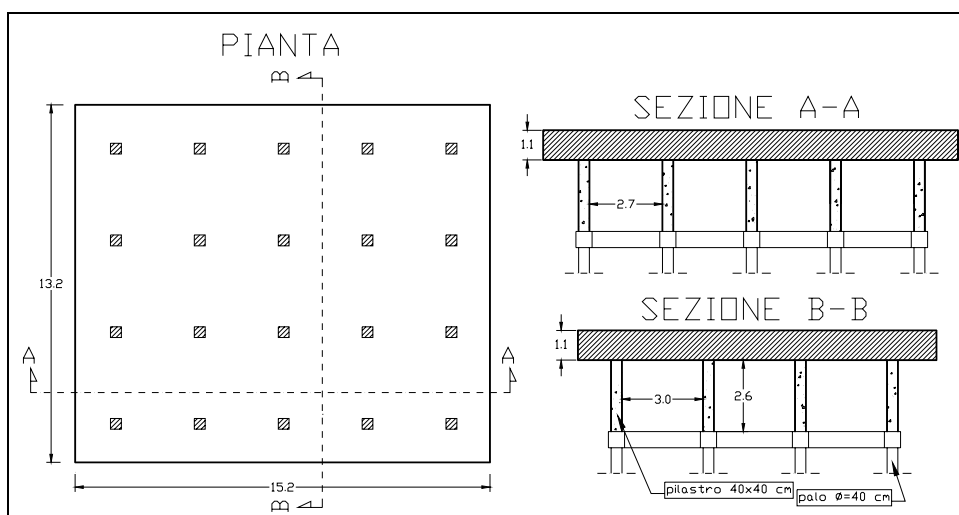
Pianta e sezioni del piastrone C (misure in m)
